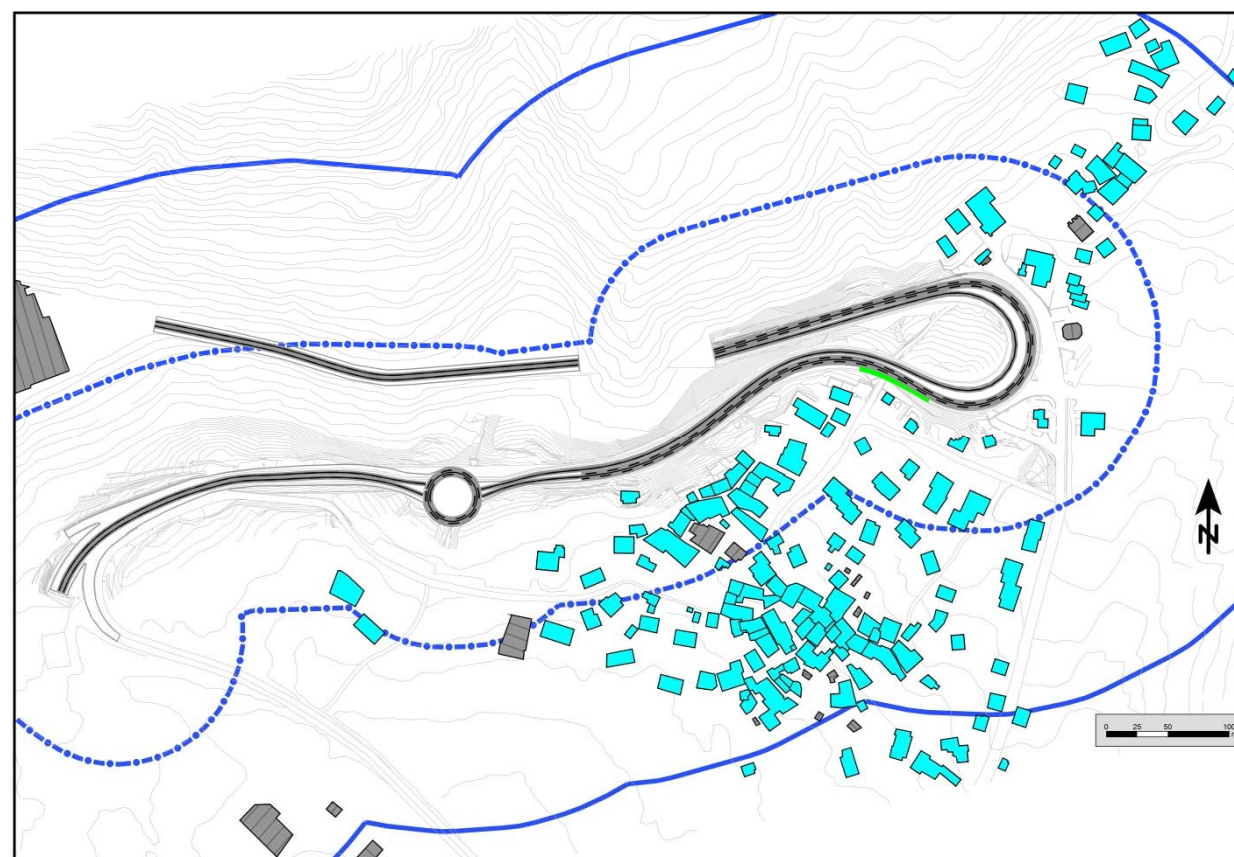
LOCALIZZAZIONE BARRIERA DI PROGETTO
